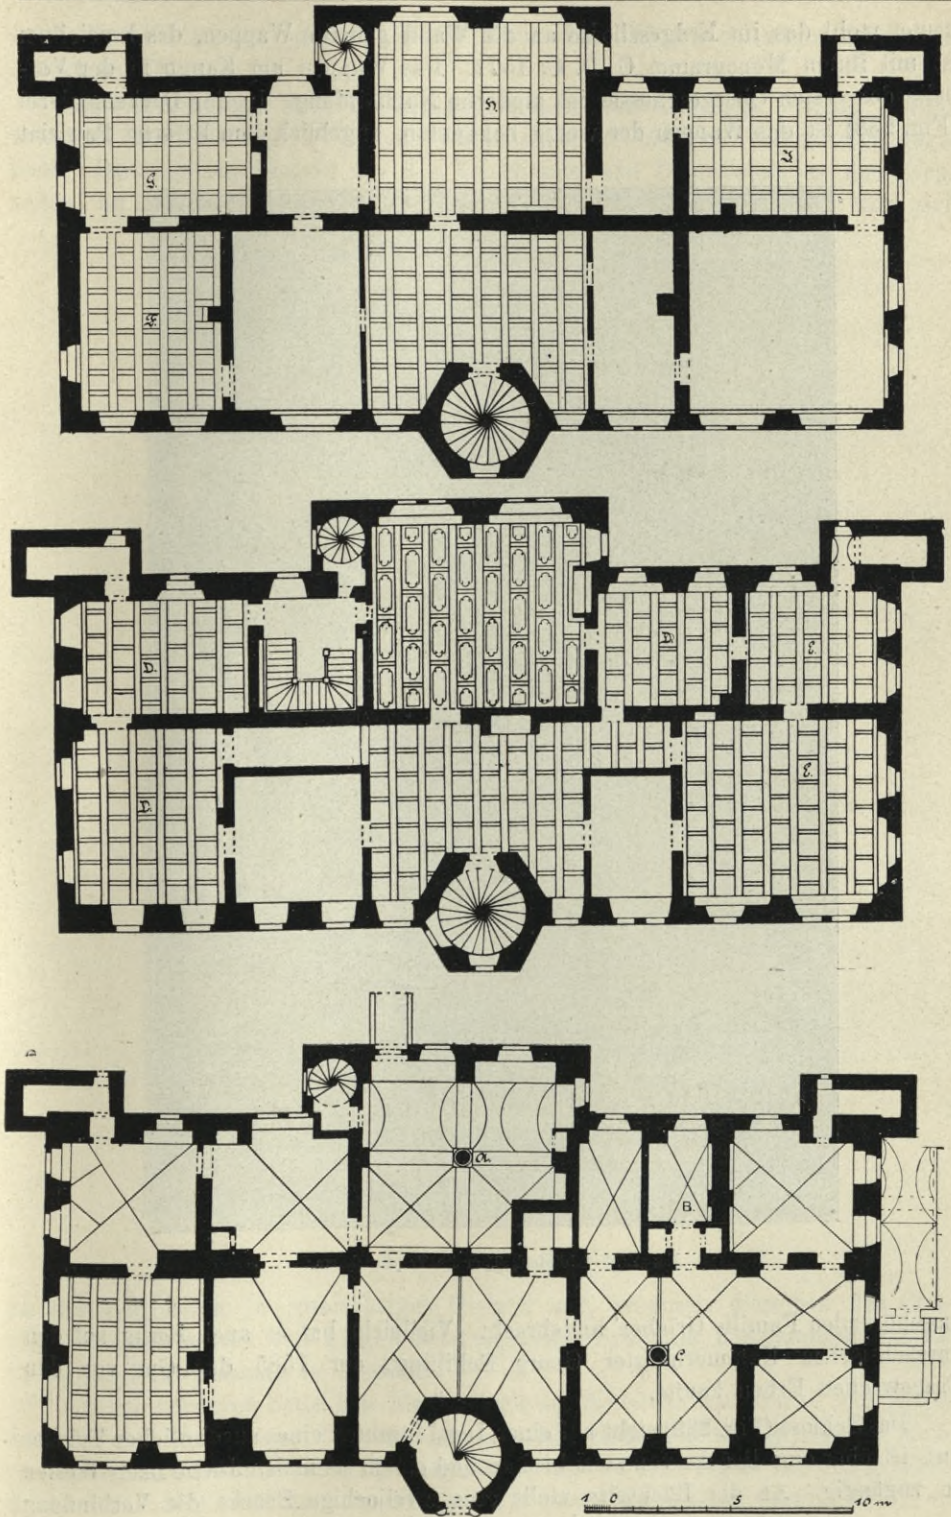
236. Schönfeld, Schloss, Grundrisse der drei Geschosse.
